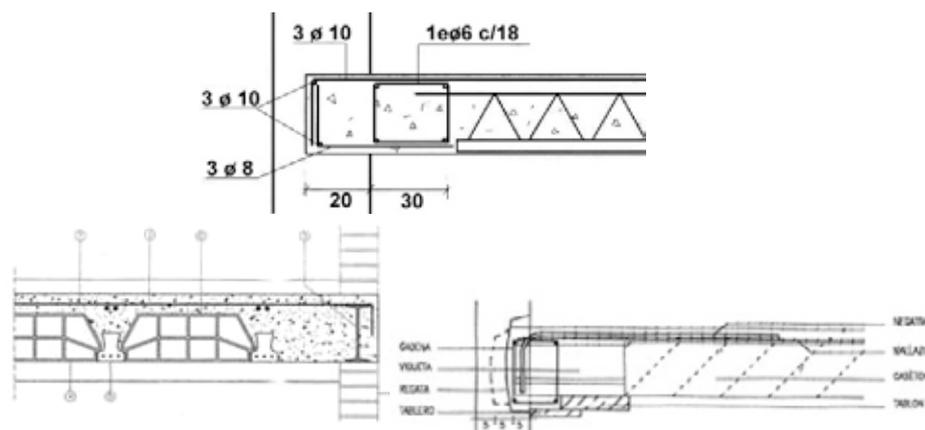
Detalle de los nuevos forjados y su apoyo en los muros pre-existentes.
